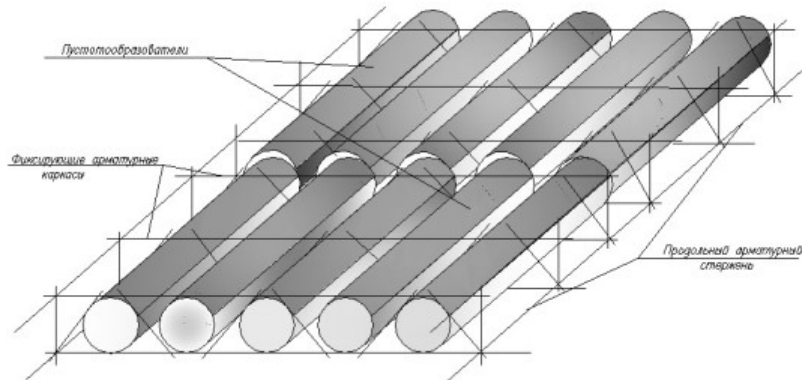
Схема закрепления круглых пустотообразователей фиксирующими арматурными каркасами.
